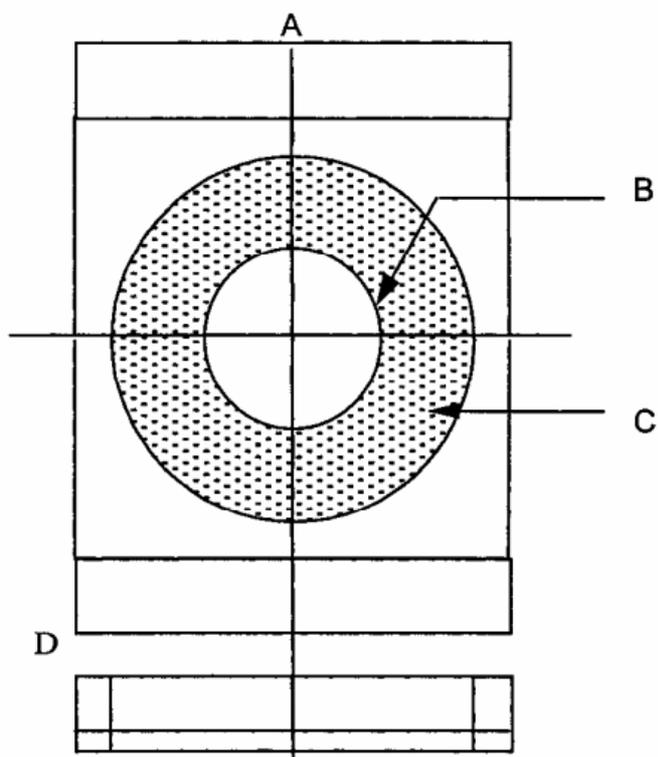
Пример установки топки с горизонтальными выхлопными патрубками в испытательной конструкции
